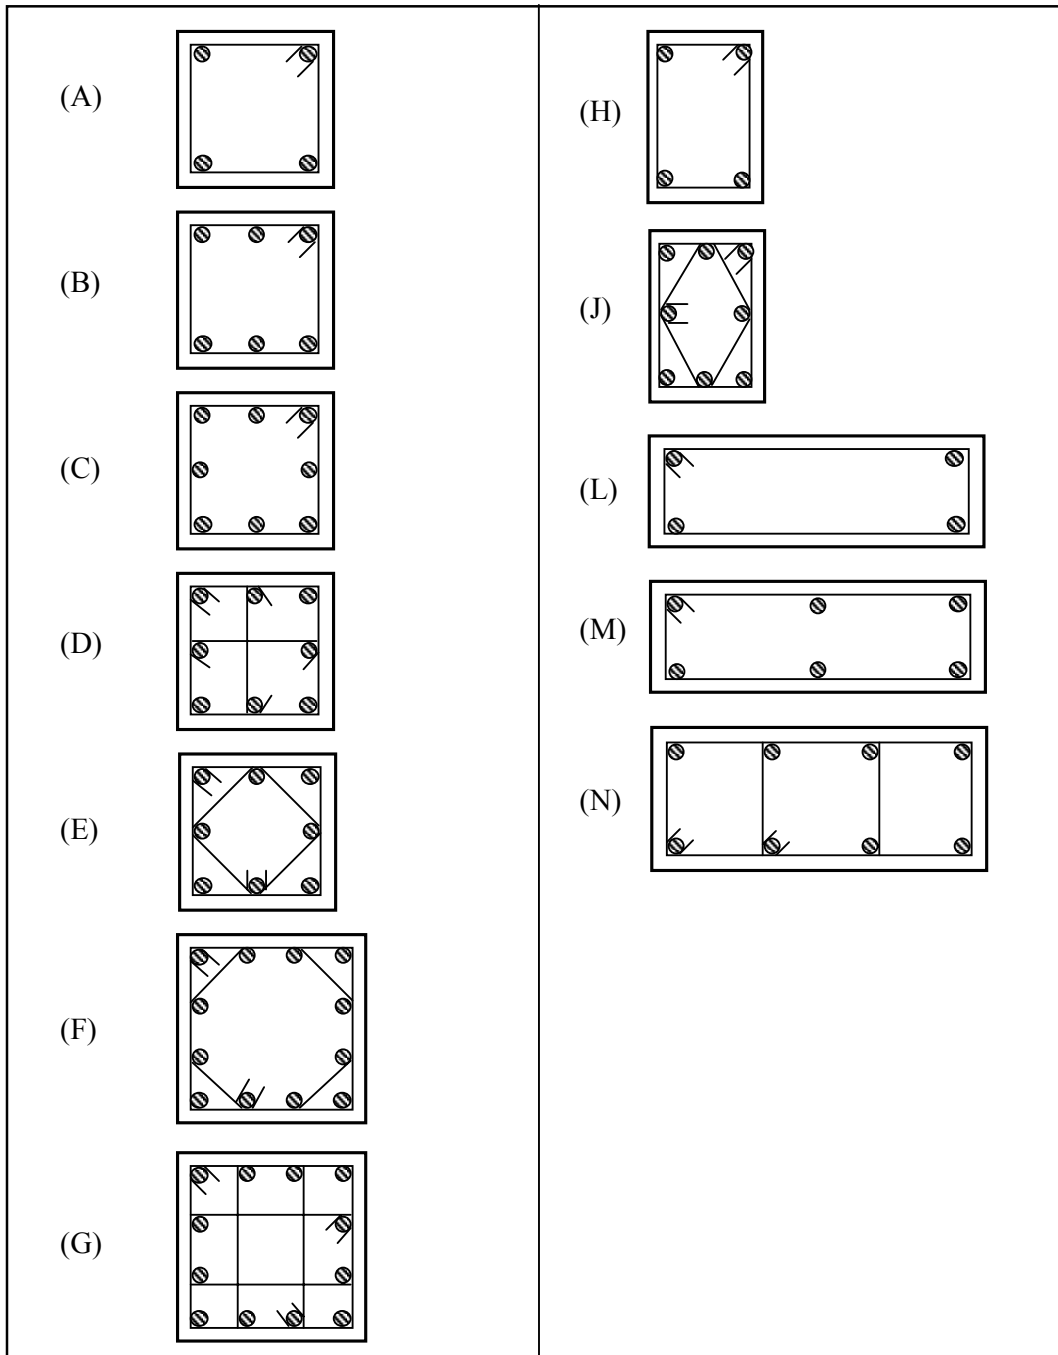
Tipos de arranjo das armaduras longitudinal e transversal dos elementos ensaiados.
